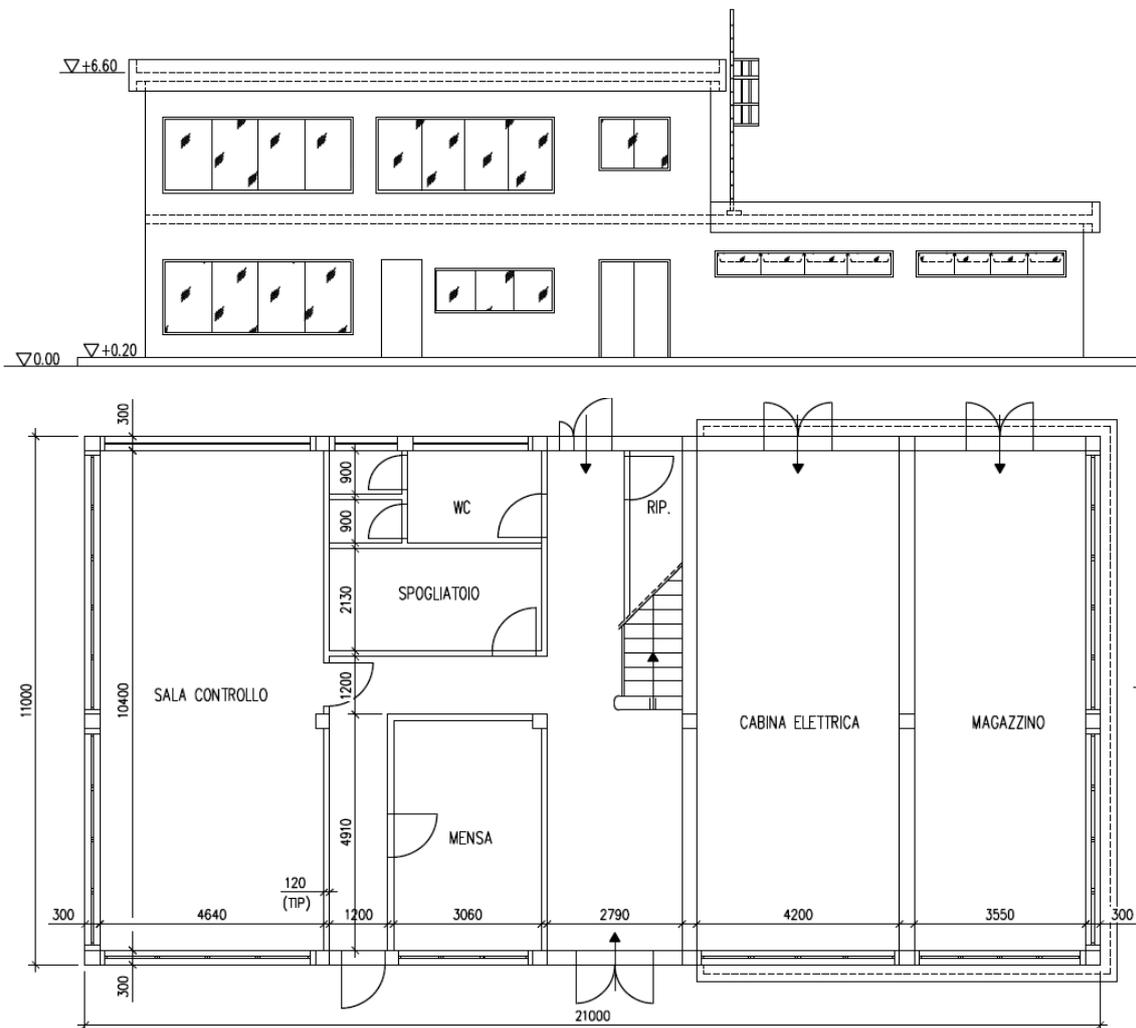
PROSPETTO TIPO E PLANIMETRIA PRIMO PIANO DELL'EDIFICIO MULTIFUNZIONE
